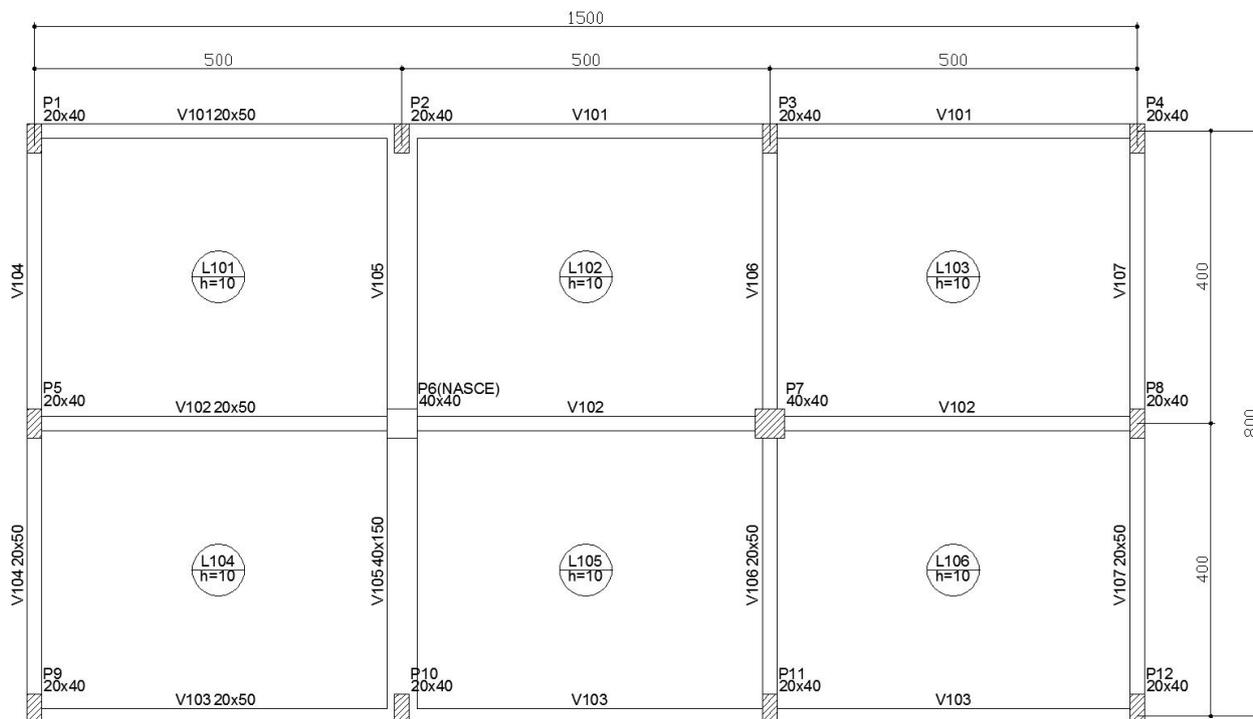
Forma pavimento 1º Teto do projeto simplificado.
